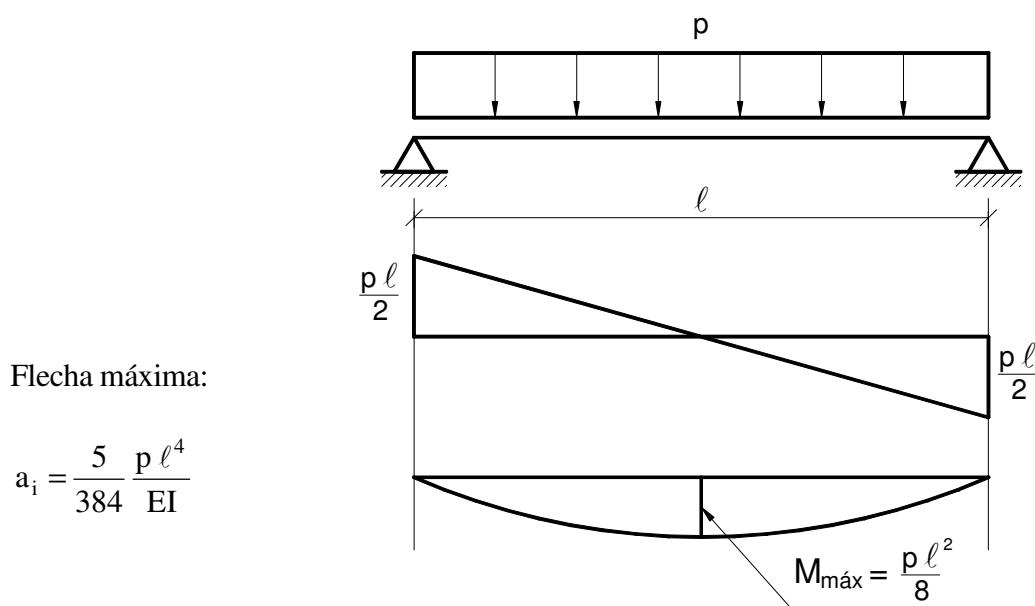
Laje armada em uma direção sobre apoios simples e com carregamento uniforme.
